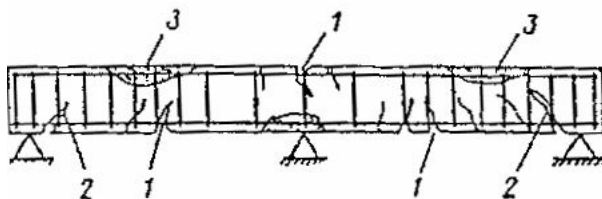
Характерные трещины в изгибаемых железобетонных элементах, работающих по балочной схеме
